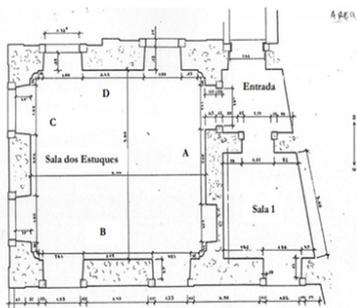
Planta da Casa de Pesca (escala 1:50), DGEMN.
